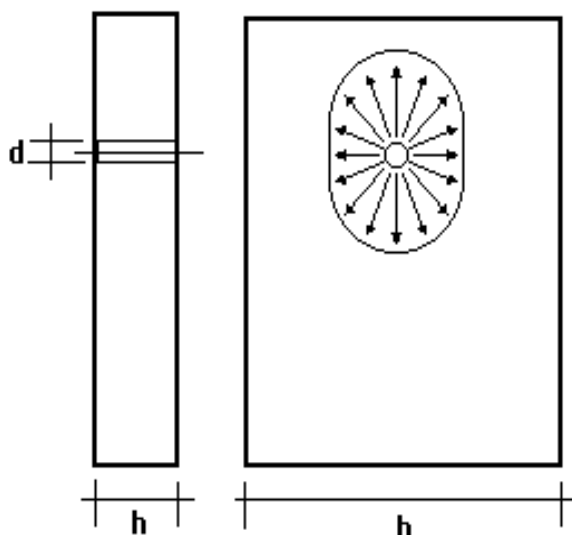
Estado de tensões causado pela cravação do prego - fonte: ALMEIDA(1987)
